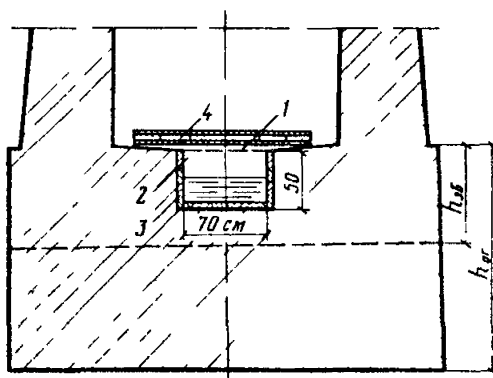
Схема устройства лотка в бетонных прямоугольных трубах:
